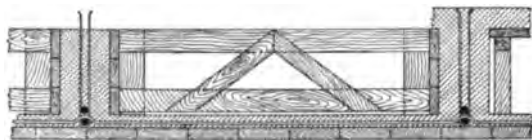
Verschalung einer unten ebenen Eisenbetondecke.
